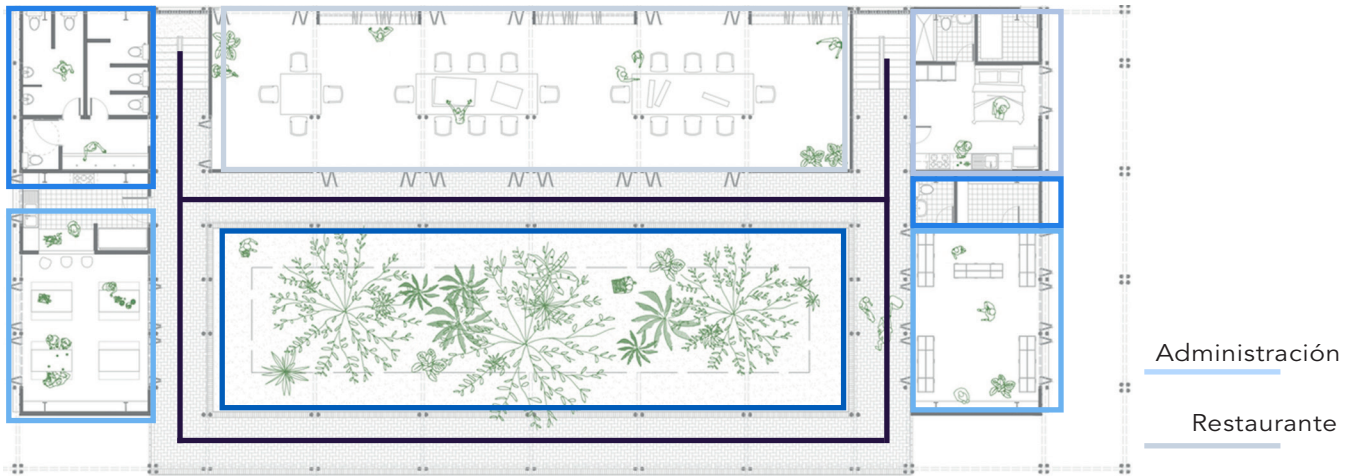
"Las Tejedoras" – Planta bajas - Zonas
